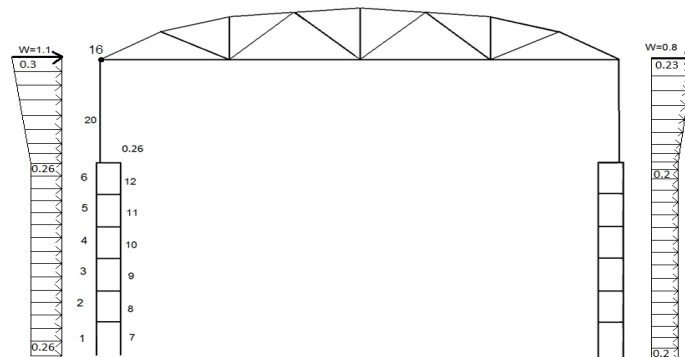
Схема от загрузки ветровой нагрузкой
